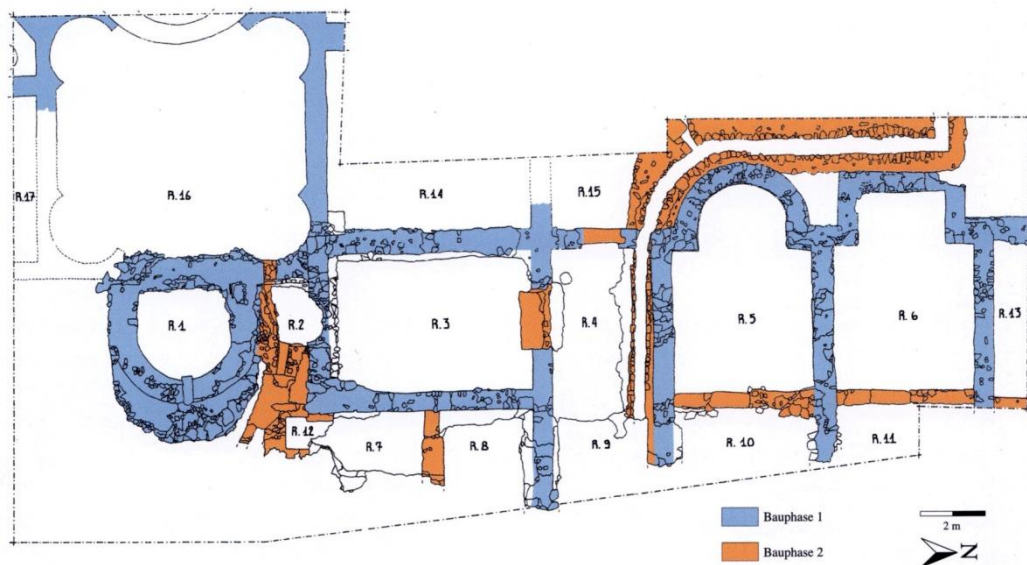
Grundriss der spätantiken Villa bei St. Pauls, Stand 2008 (Norden rechts).
